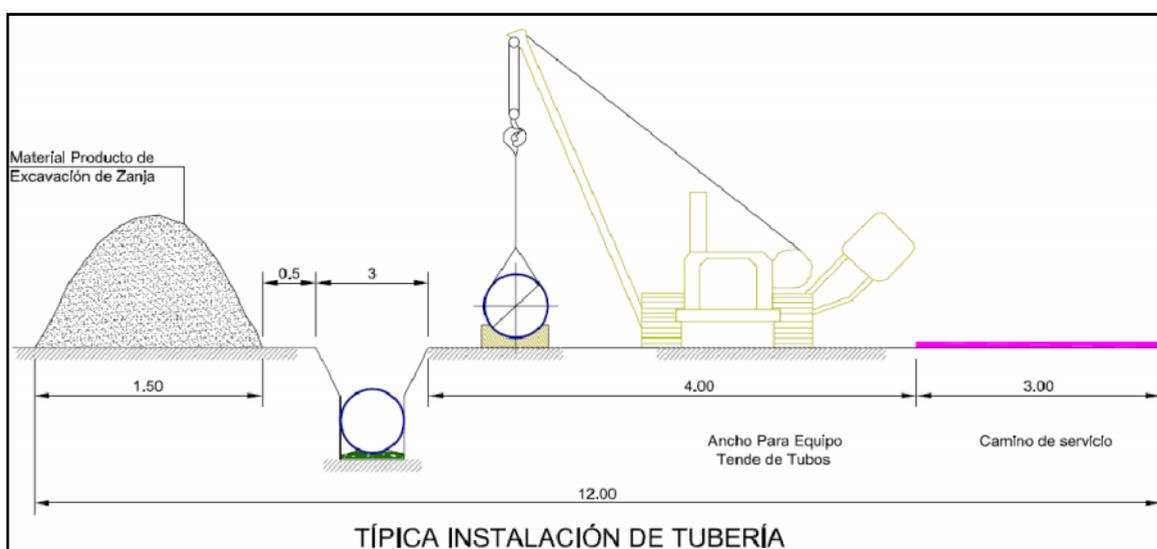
, Detalle la construcción de la tubería a ser implantada en el proyecto.
